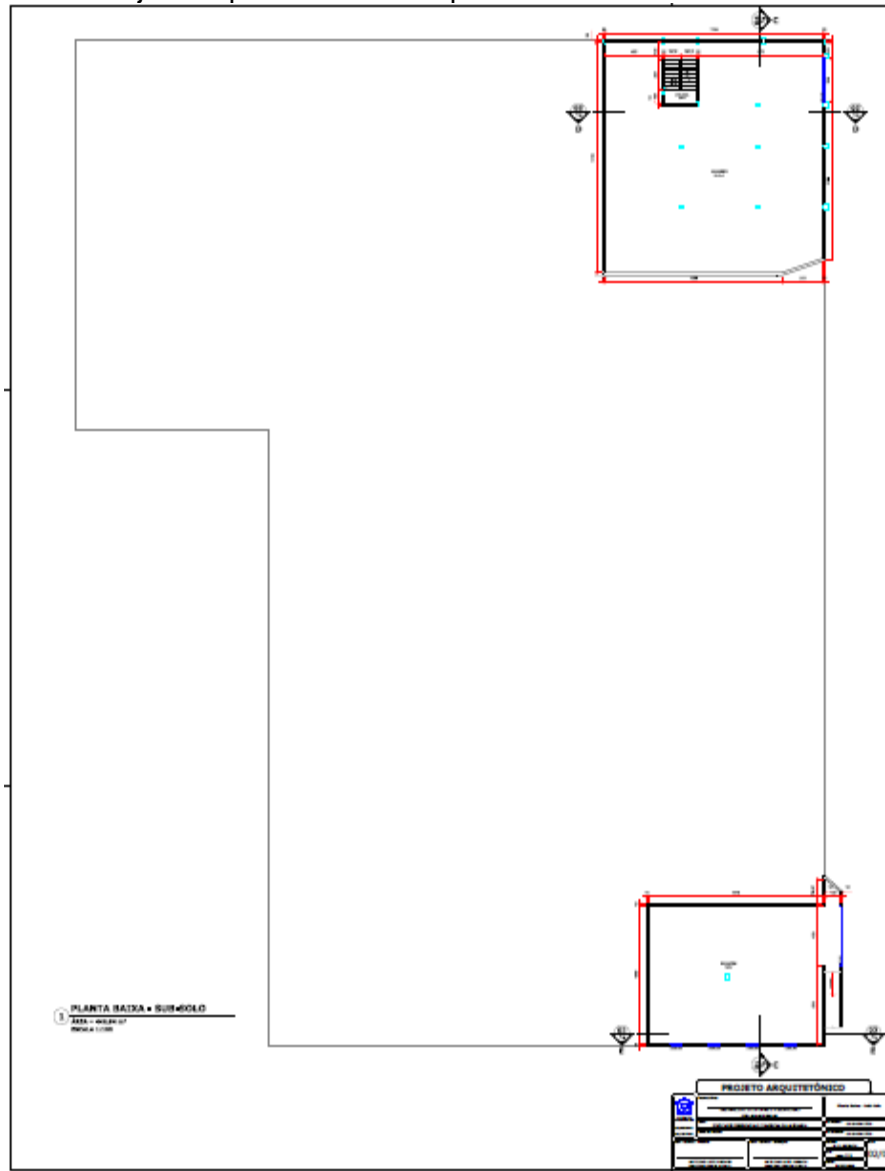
Projeto arquitetônico do empreendimento - Situação.
